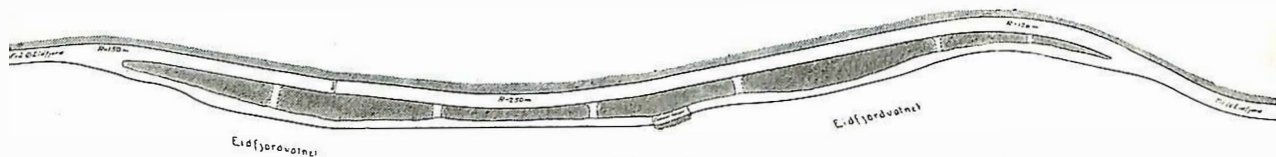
Vegutvidinga på Eidfjordvegen. Grunnriss av den 450 m lange tunnelen.
